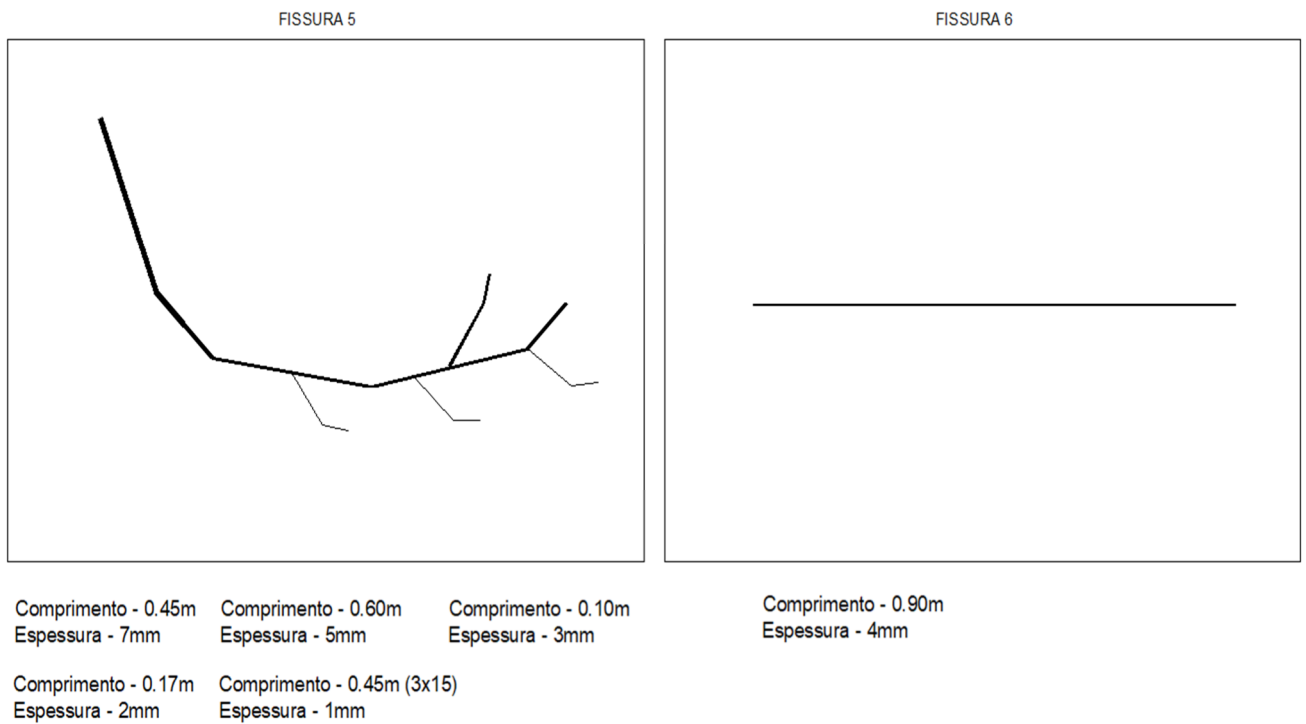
Fissuras 5 e 6 criadas em AutoCAD
